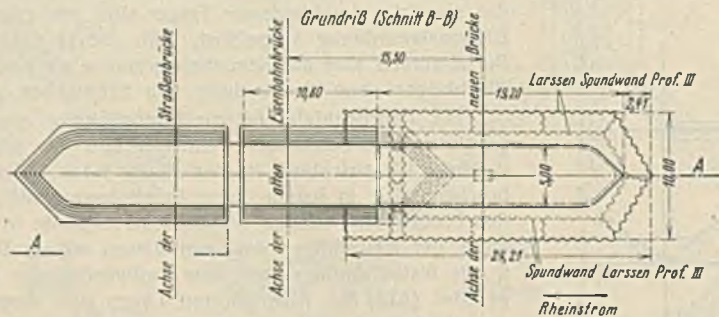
Stropfpfeilergründung mit ortsfestem Eisenbetonsenkasten.
